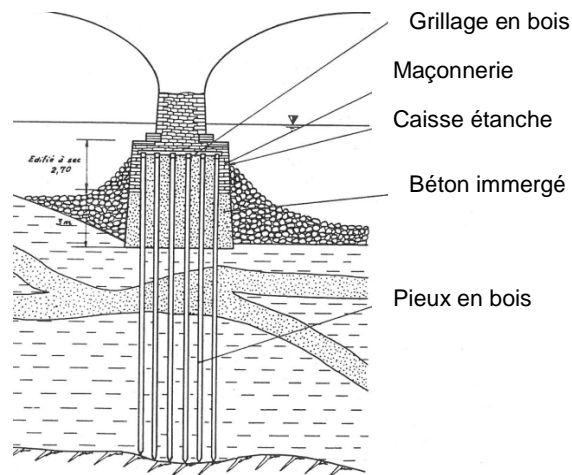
Fondations du pont de la Morinière (modifié d'après [Levillain, 1980](#))
